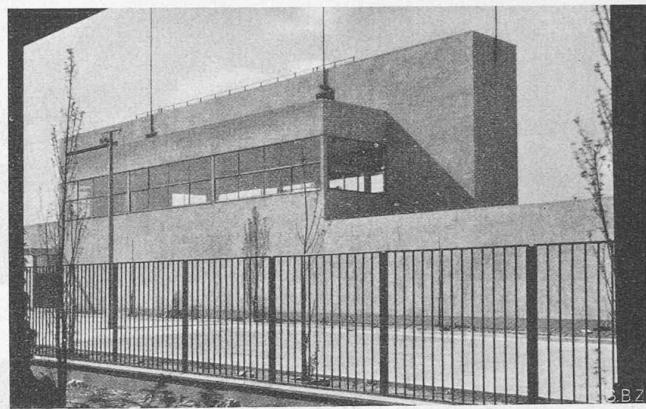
Turnhalle vom Erdgeschoss-Hof des Schulhauses aus.
